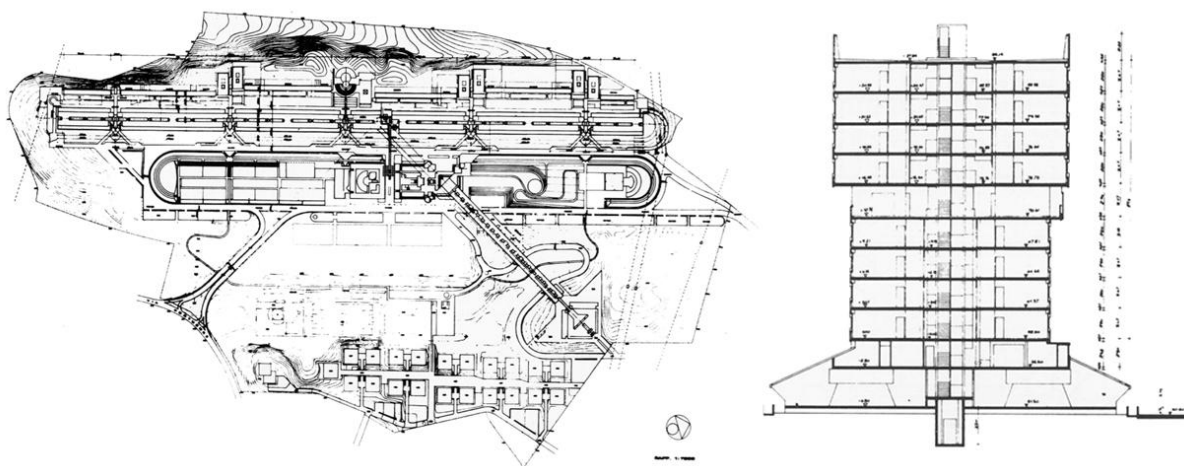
| Piano di Zona n.61, 'Corviale': planimetria generale e sezione dell'edificio principale.
